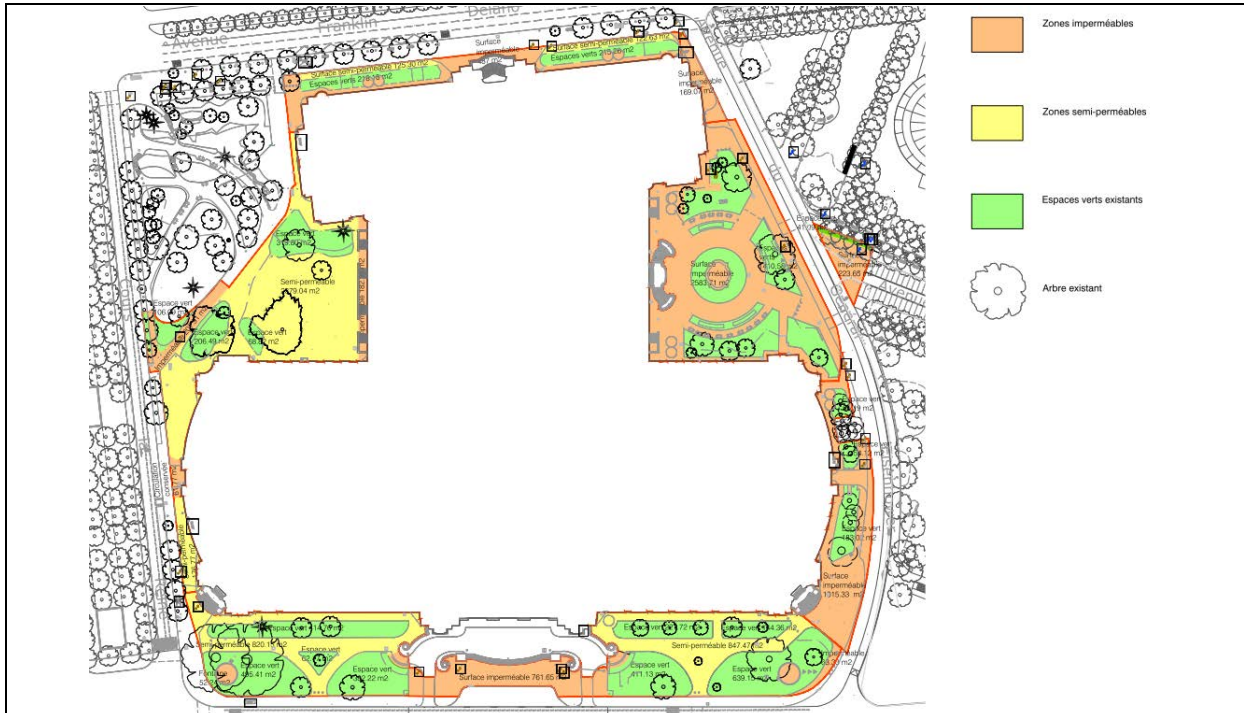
Plan actuel des zones perméables, semi-perméables et imperméables
